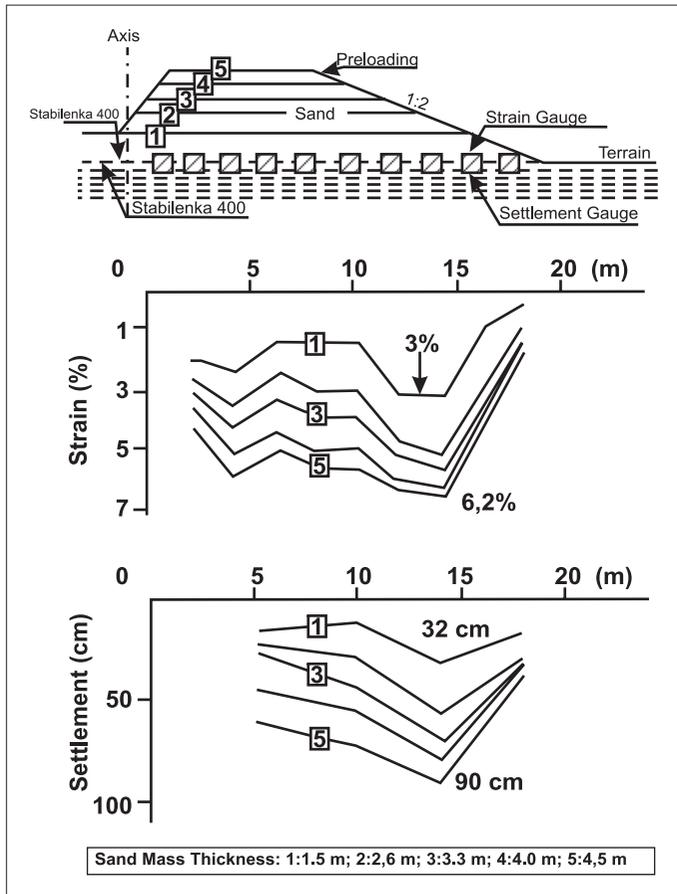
Мониторинг насыпи на слабом основании, армированной плоской георешеткой Fortrac на железнодорожной ветке Магдебург – Берлин (Германия)
